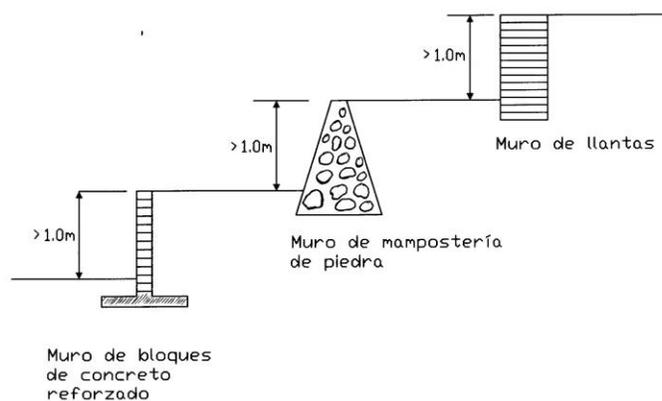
Tipos de muro utilizados para la conformación de terrazas
